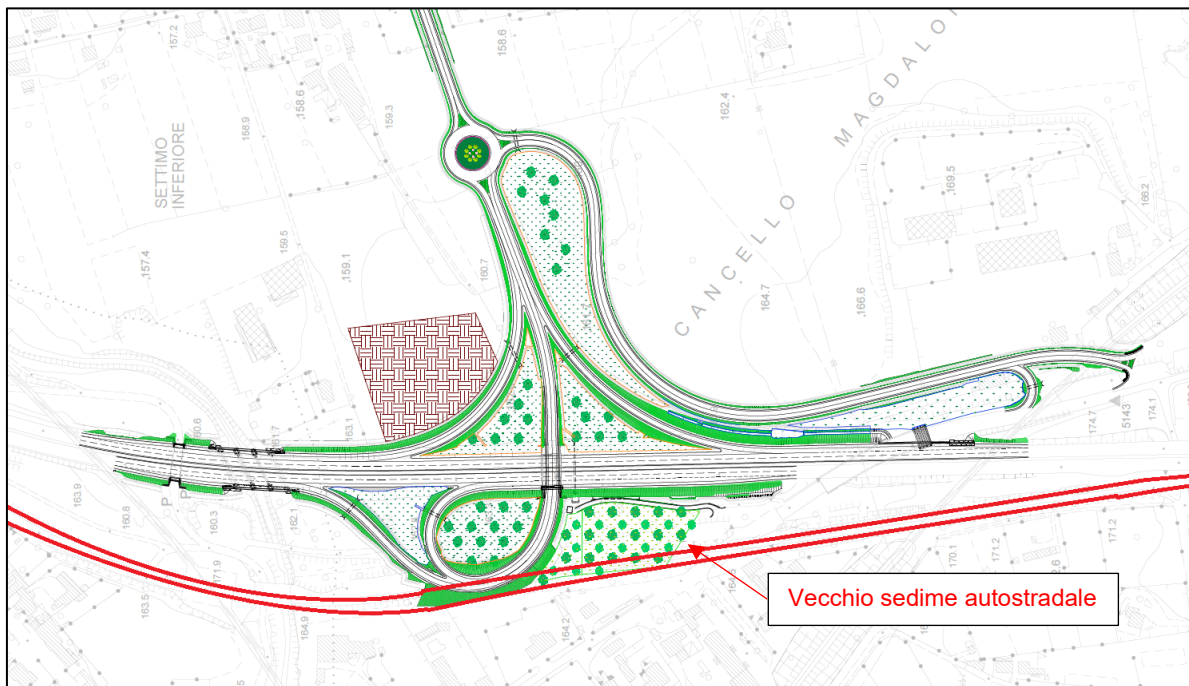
Stralcio della Planimetria delle Opere a Verde
